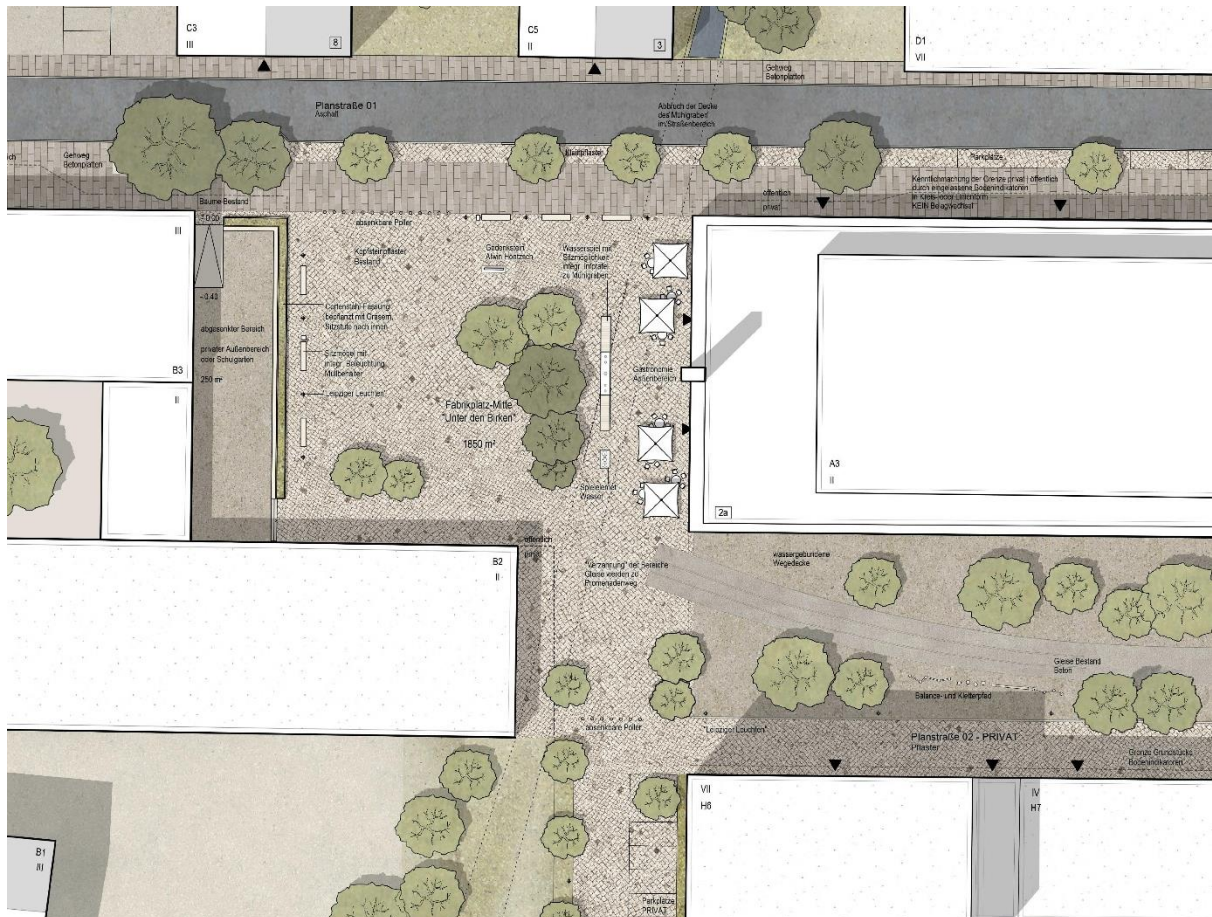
| Ausschnitt Gestaltungsplan Fabrikplatz (Stand 01/2025)
